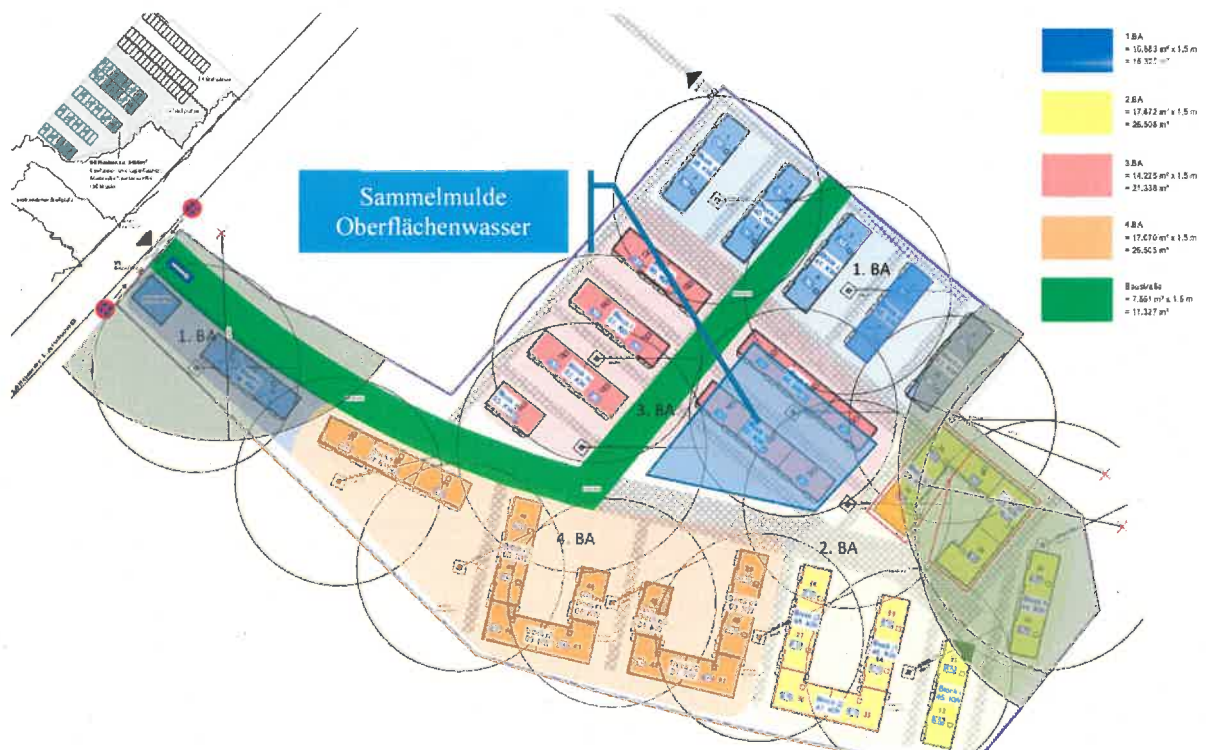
Lageplan mit Eintragung der Bauabschnitte
